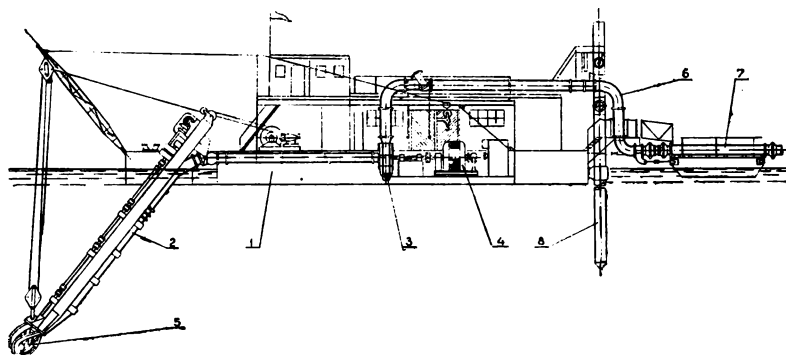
Землесосный снаряд с фрезерным разрыхлителем.
